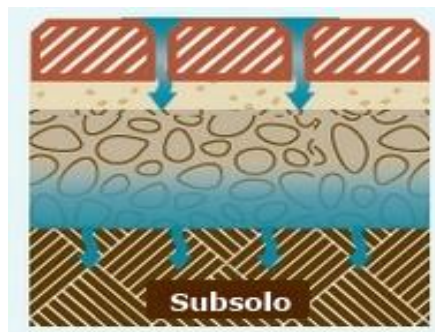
Pavimento permeável de infiltração (adaptado de <http://www.paveshare.org/library/picp-design-sizing>)
